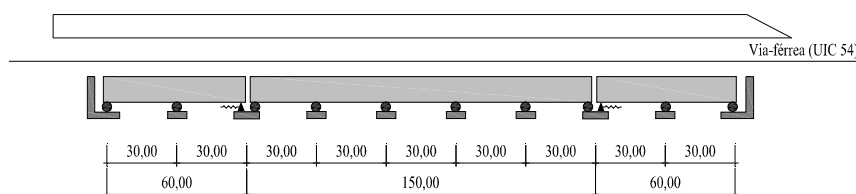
Configuração longitudinal do sistema via - estrutura de Maartensdijk
